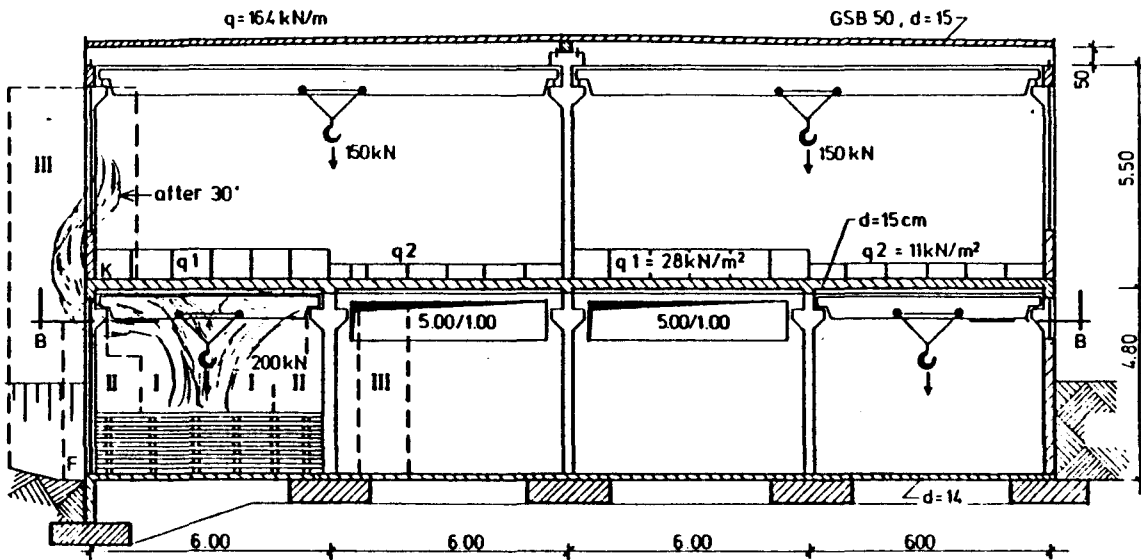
Längsschnitt durch die untersuchte stahlbeton-konstruktion
